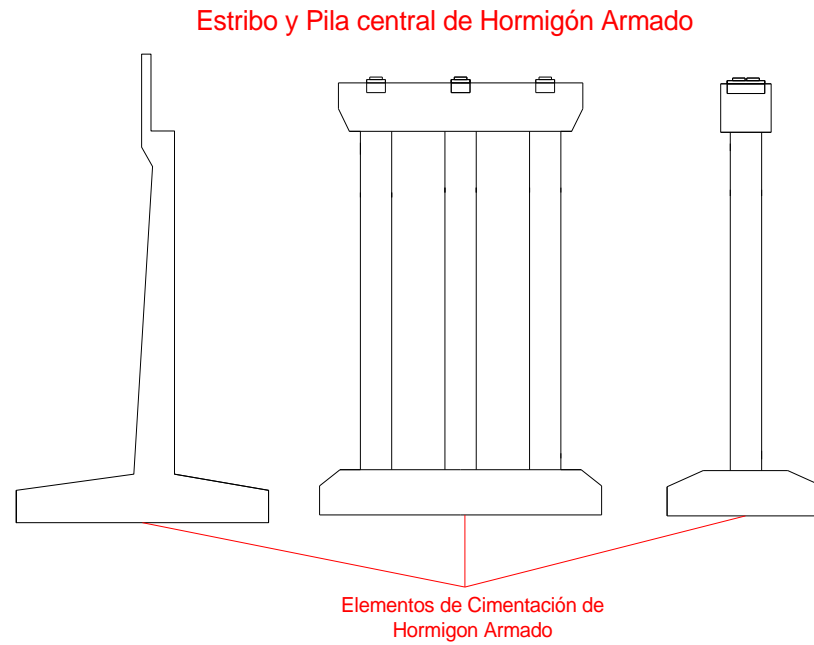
Elementos de infraestructura elegida (*Fuente elaboración propia*)
